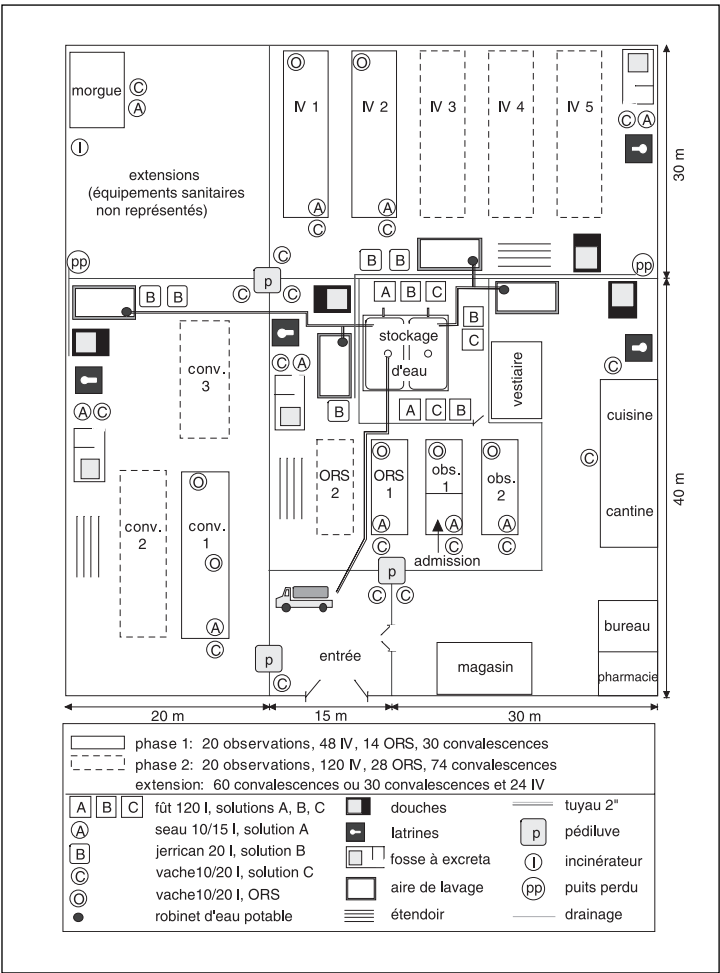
Plan type d’un CIC pour 300 patients.
